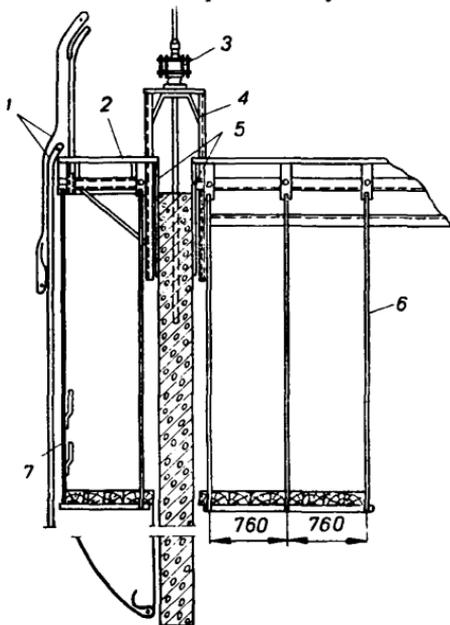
Схема устройства тепляка вокруг наружных стен:
